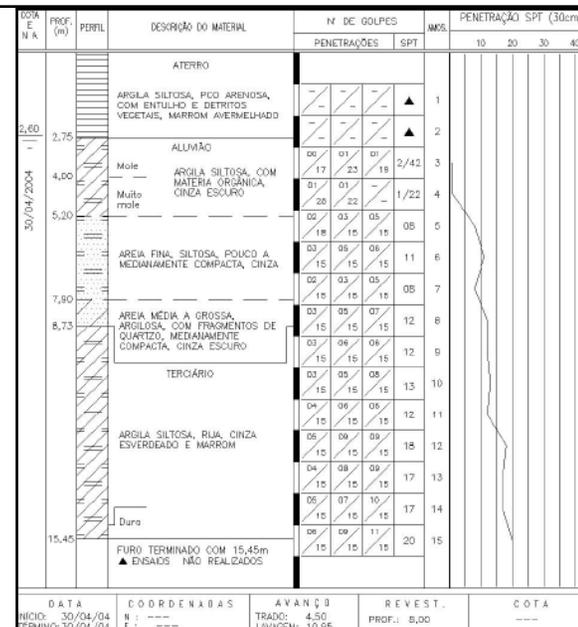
Perfil Geotécnico – SP - 03 – Córrego Água Preta
